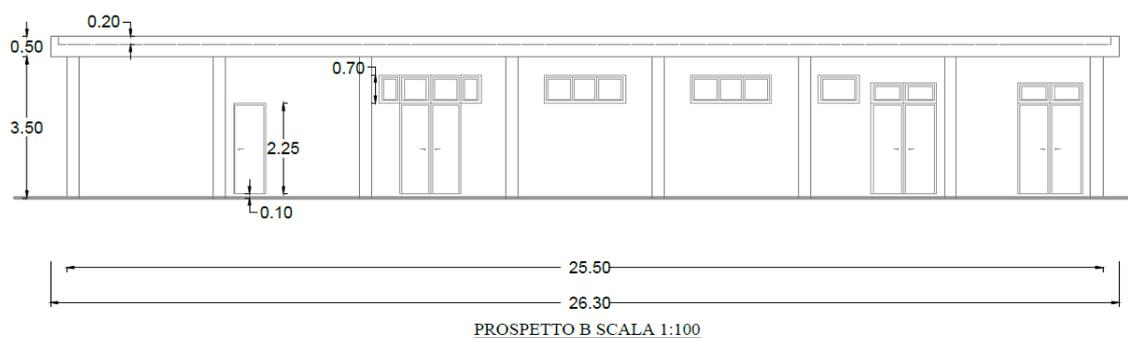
Prospetto locale tecnico della Sottostazione Elettrica di Utanza
